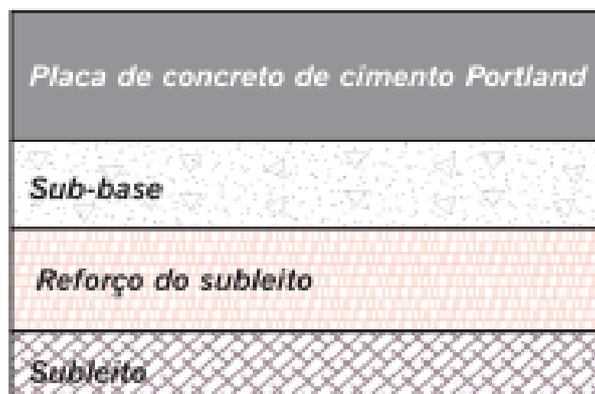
Camadas de pavimento rígido (Fonte: Fabiane, 2021).
